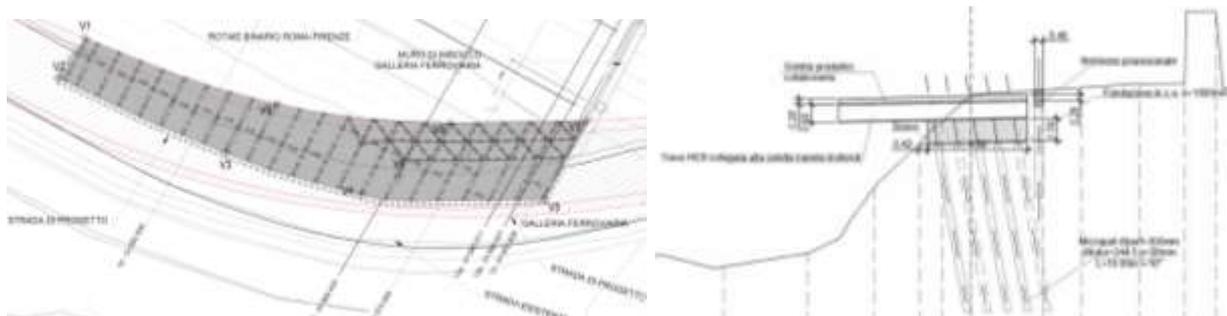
Planimetria di tracciamento - progetto "Nodo 2" (a sinistra) e sezione dell'intervento nodo 2 (a destra) (Fonte: Lista di controllo)
